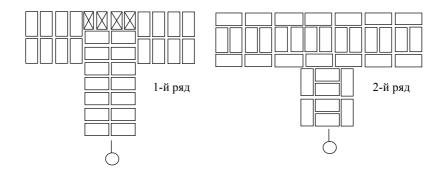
Кладка примыканий стен толщиной в 1,5 кирпича
